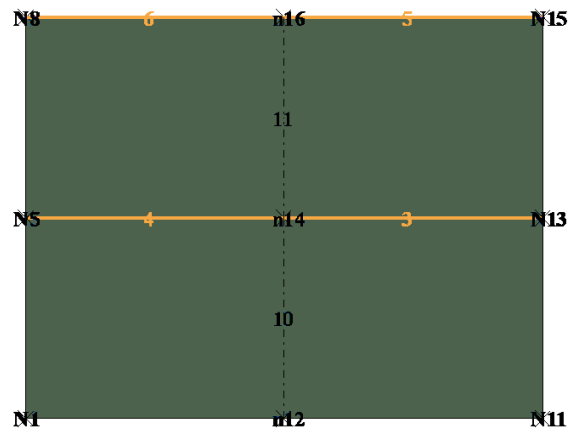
Prospetto Parete 2 - Modello Isolato
